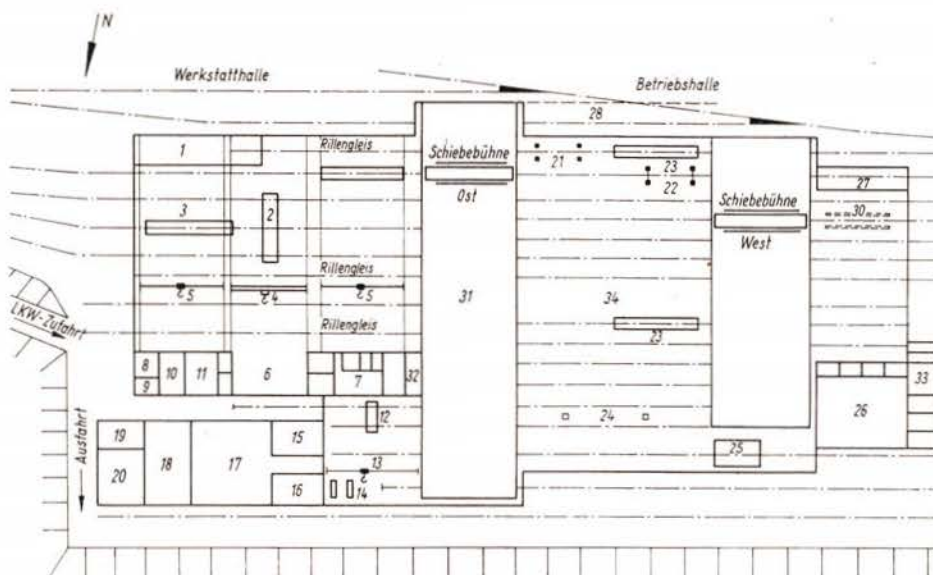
Aufbau und Ausrüstung der Triebfahrzeughalle des Bw Erfurt (Endzustand)
